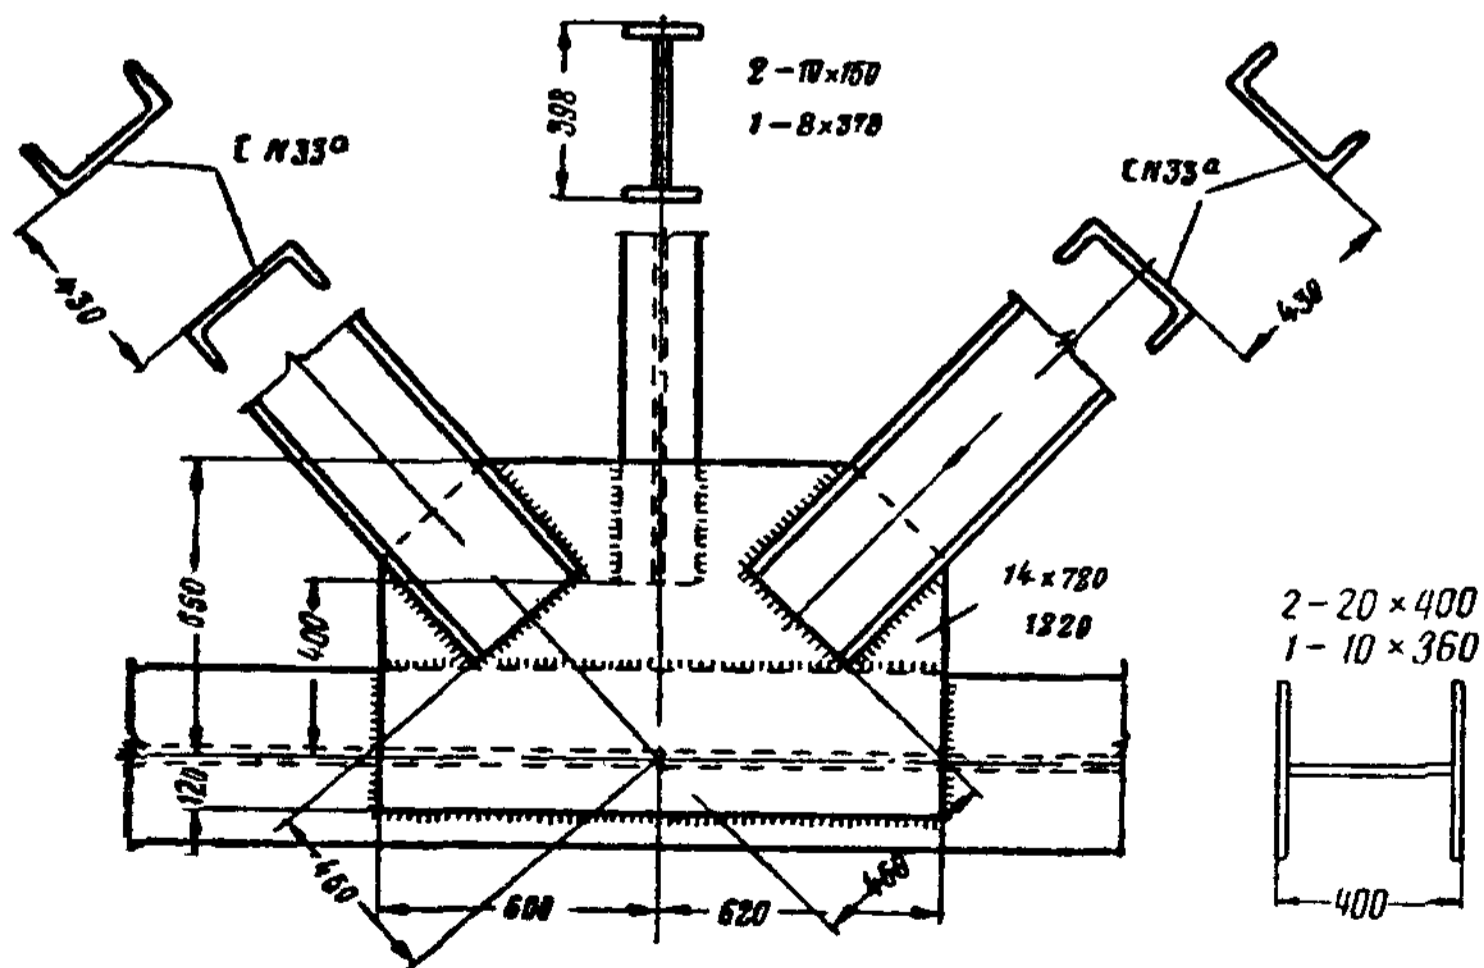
Узел сварной фермы при прикреплении стержней фланговыми швами
